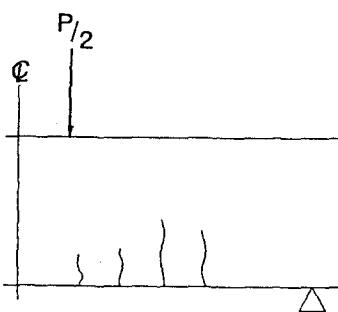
RCはりのひびわれ進展図（上部鉄筋3本）
